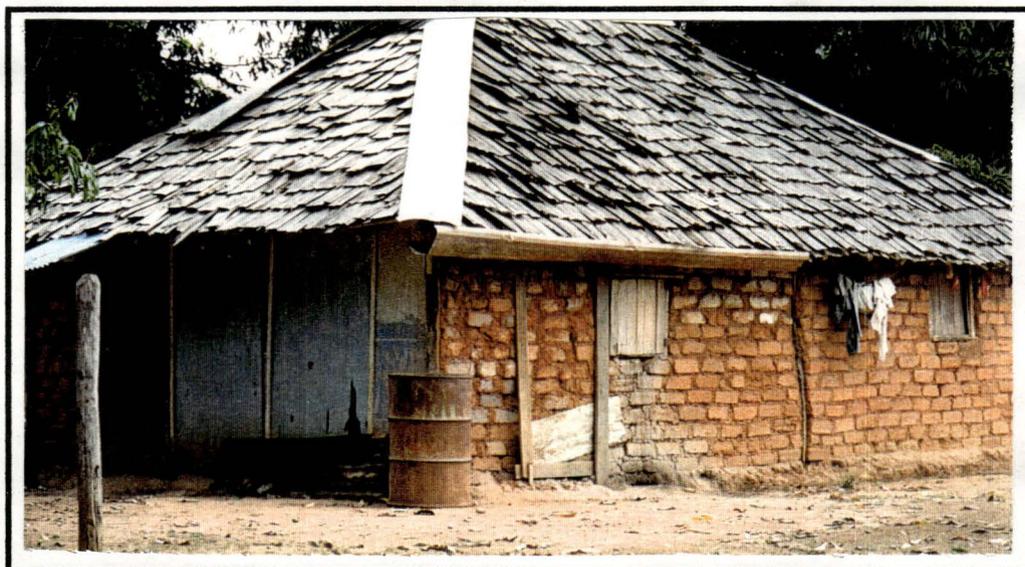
Habitação construída em adobe com cobertura de telha de madeira (cavaco).
